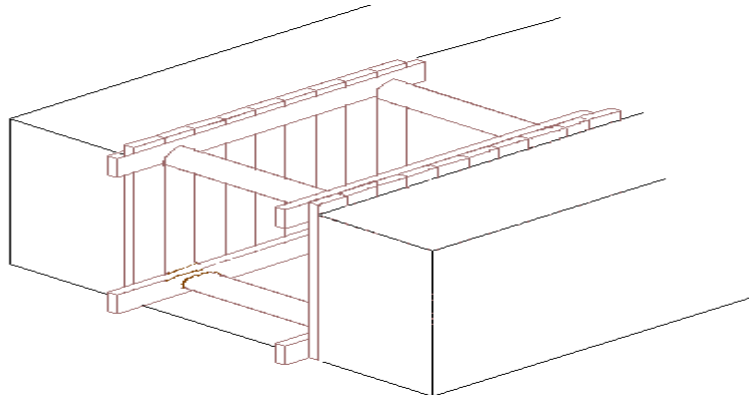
Apuntalamiento de paredes de las excavaciones
